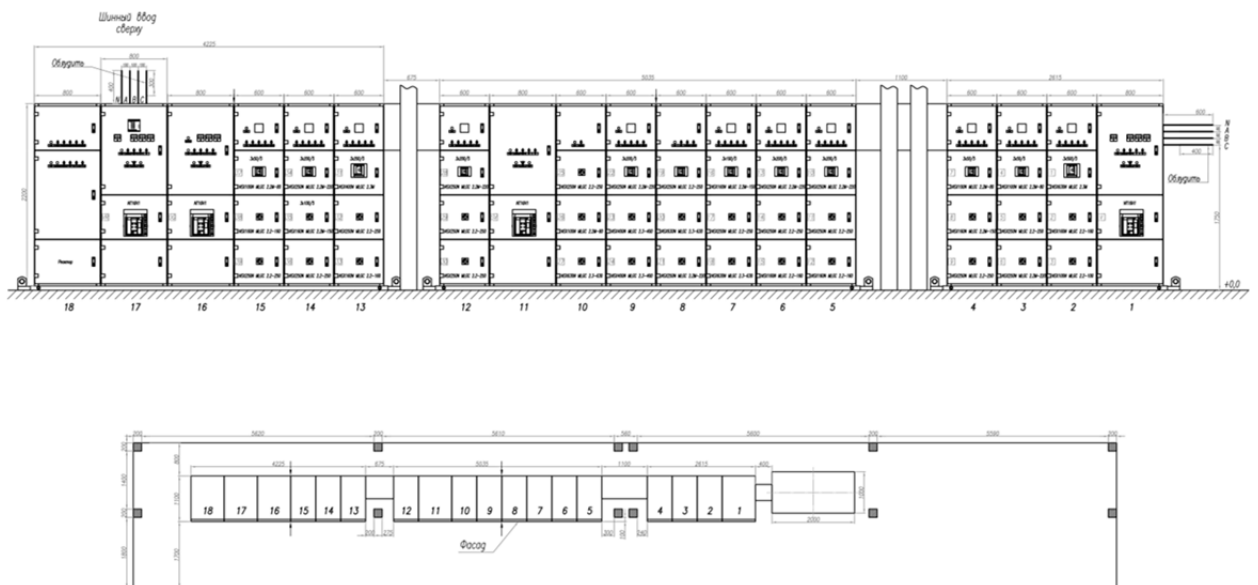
Внешний вид и габаритные размеры КТП
